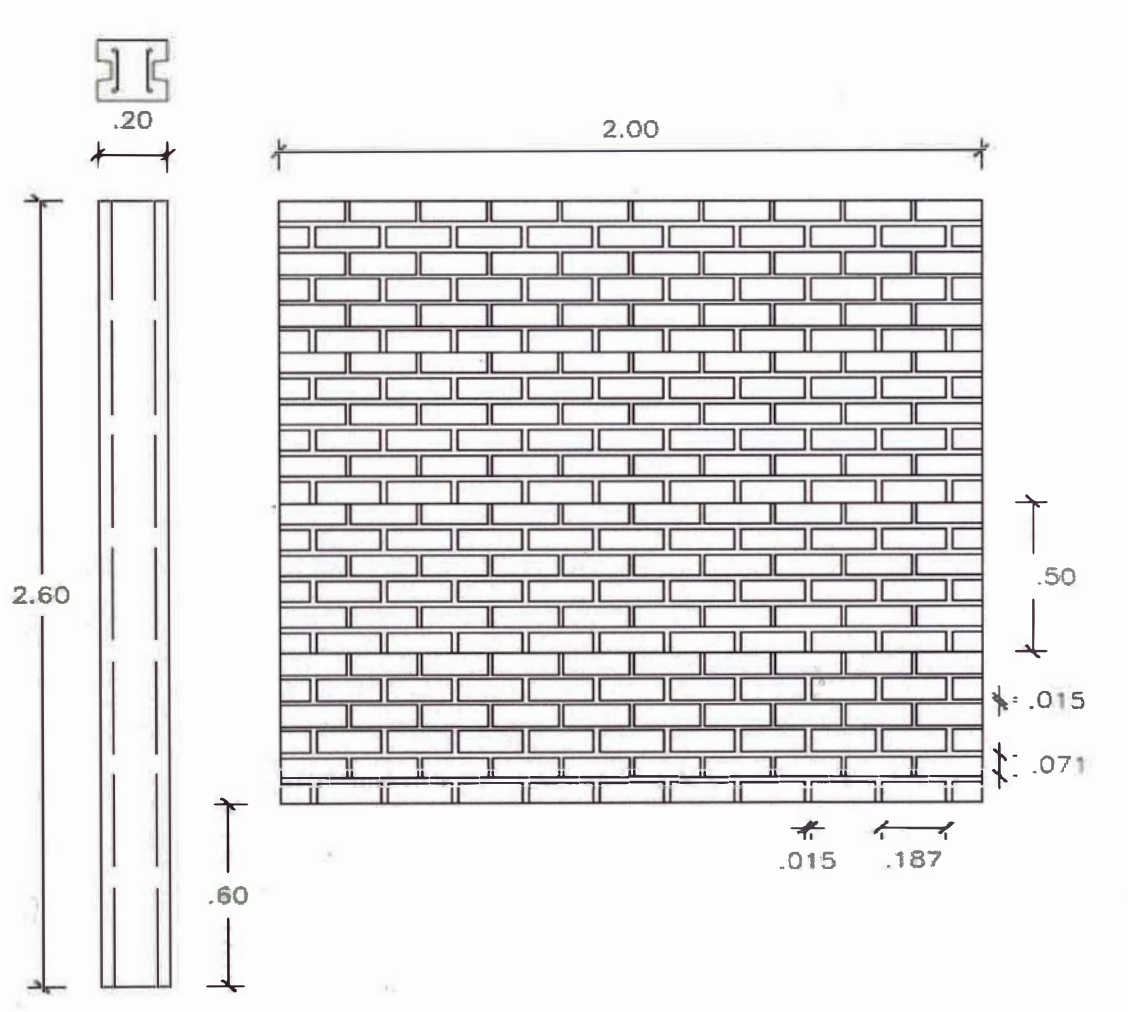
Esquema de unión de elementos de columnas y muros
